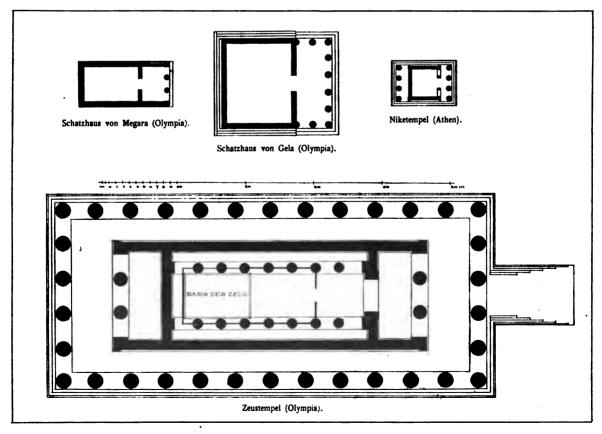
(11). Vier Tempelgrundrisse im gleichen Massstab.
